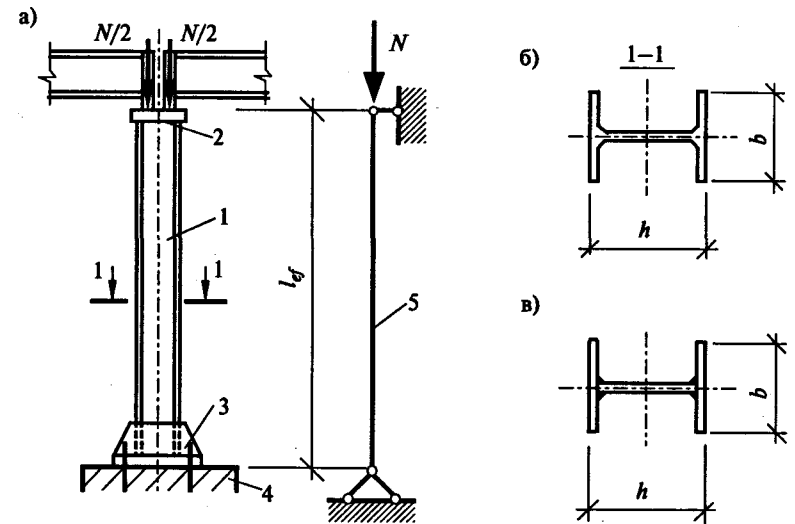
Сплошная центрально-сжатая колонна: а) конструкция; б) сечение из прокатной двутавровой балки; в) двутавровое сечение, сваренное из листов; 1 — стержень колонны; 2 — оголовок колонны; 3 — база колонны; 4 — фундамент; 5 — расчетная схема
